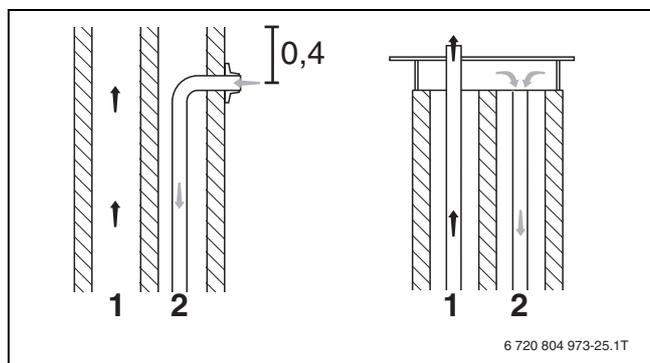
Exemples de construction d'ouvertures (dimensions en m)
